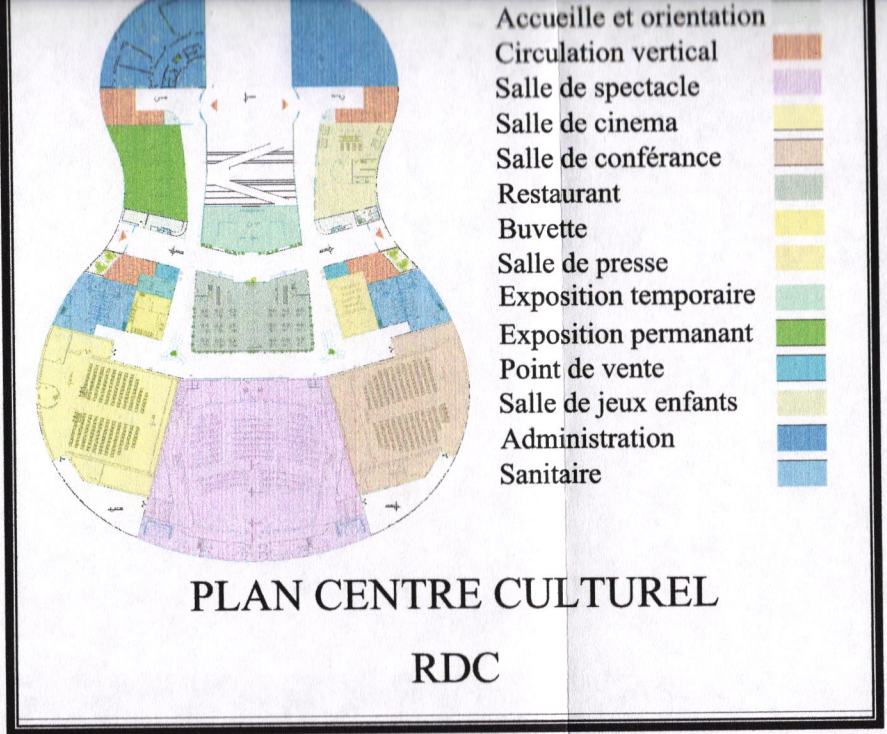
PLAN DE CENTRE CULTUREL RDC
